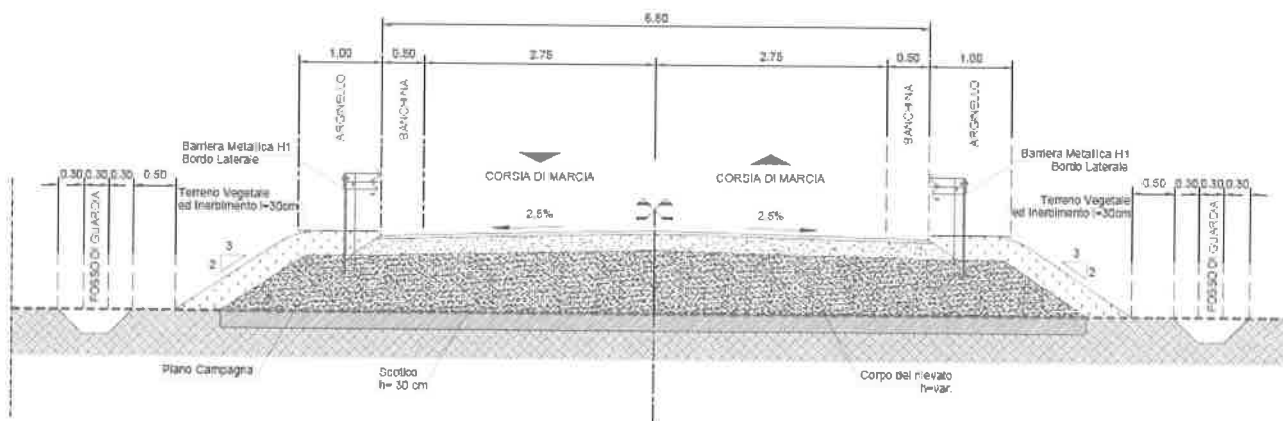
Sezione Tipo in Rilevato $h > 1,00$ m
